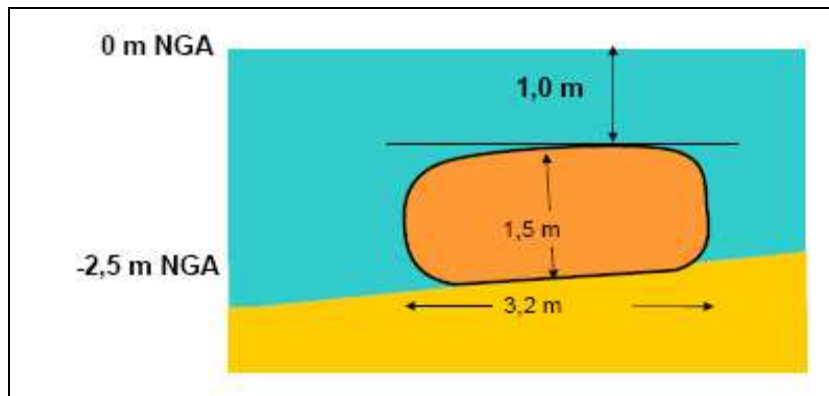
Section-type des boudins géotextile immergés de la variante n°5 a de protection de Palm Beach.
